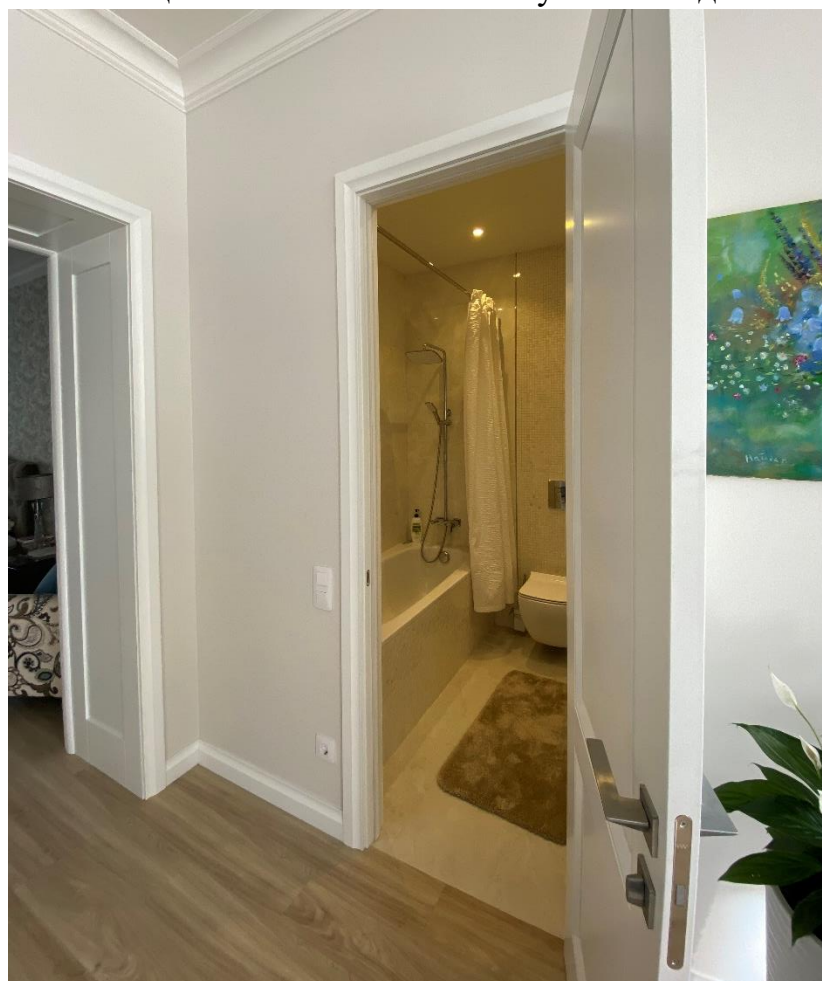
Помещение № 4 согласно плану ПИБ. Вид с северо-запада
